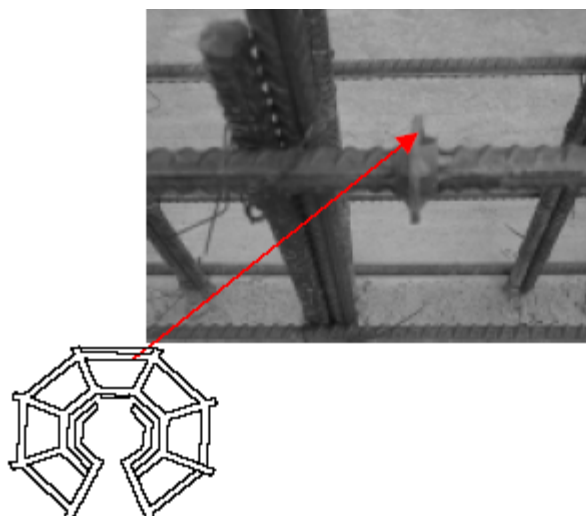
2 柱、梁卡子示意图 楼板钢筋 PVC 垫块示意图
